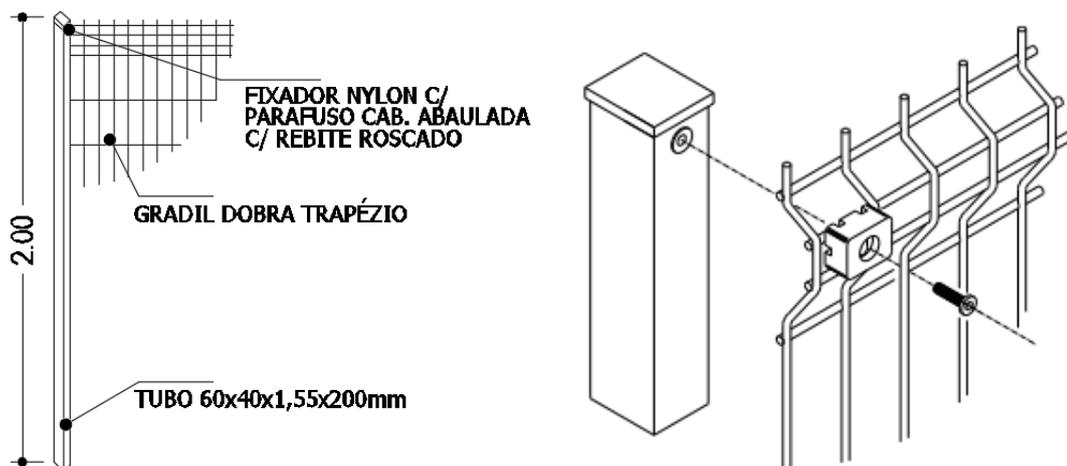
Pilar Tubular 60x40x1,55x200mm e Detalhe de Fixação do Gradil.
